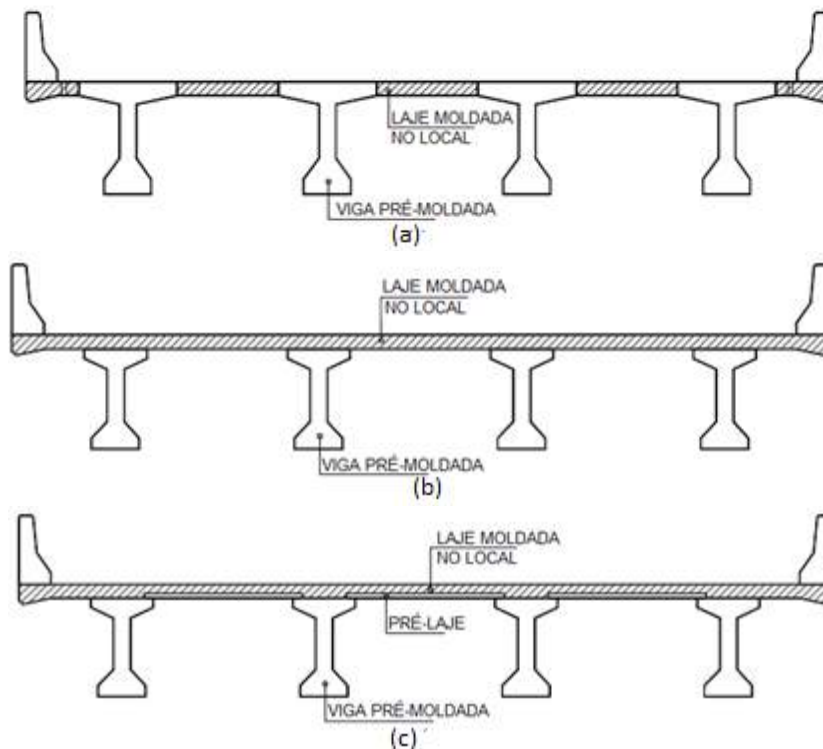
Diferentes tipos de execução de lajes utilizando-se vigas pré-moldadas protendidas: (a) laje moldada no local interposta entre as vigas; (b) laje moldada no local sobre as vigas; (c) laje parcialmente pré-moldada. Fonte: PINHO (2011).
